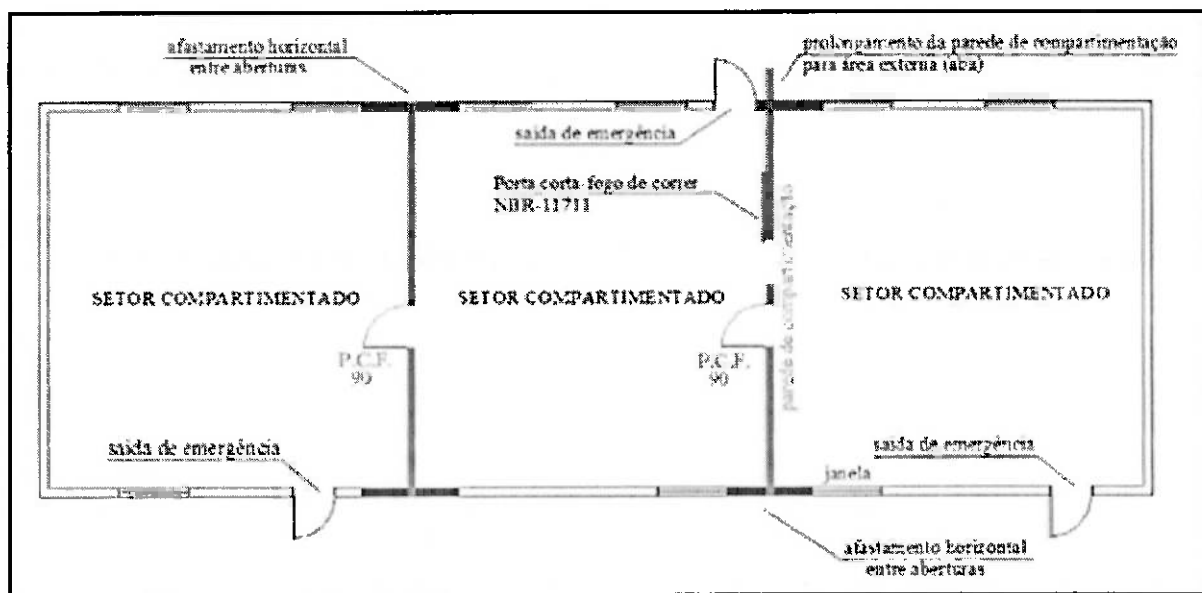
Detalhes construtivos da compartimentação horizontal (Fonte: Instrução Técnica nº 09)
